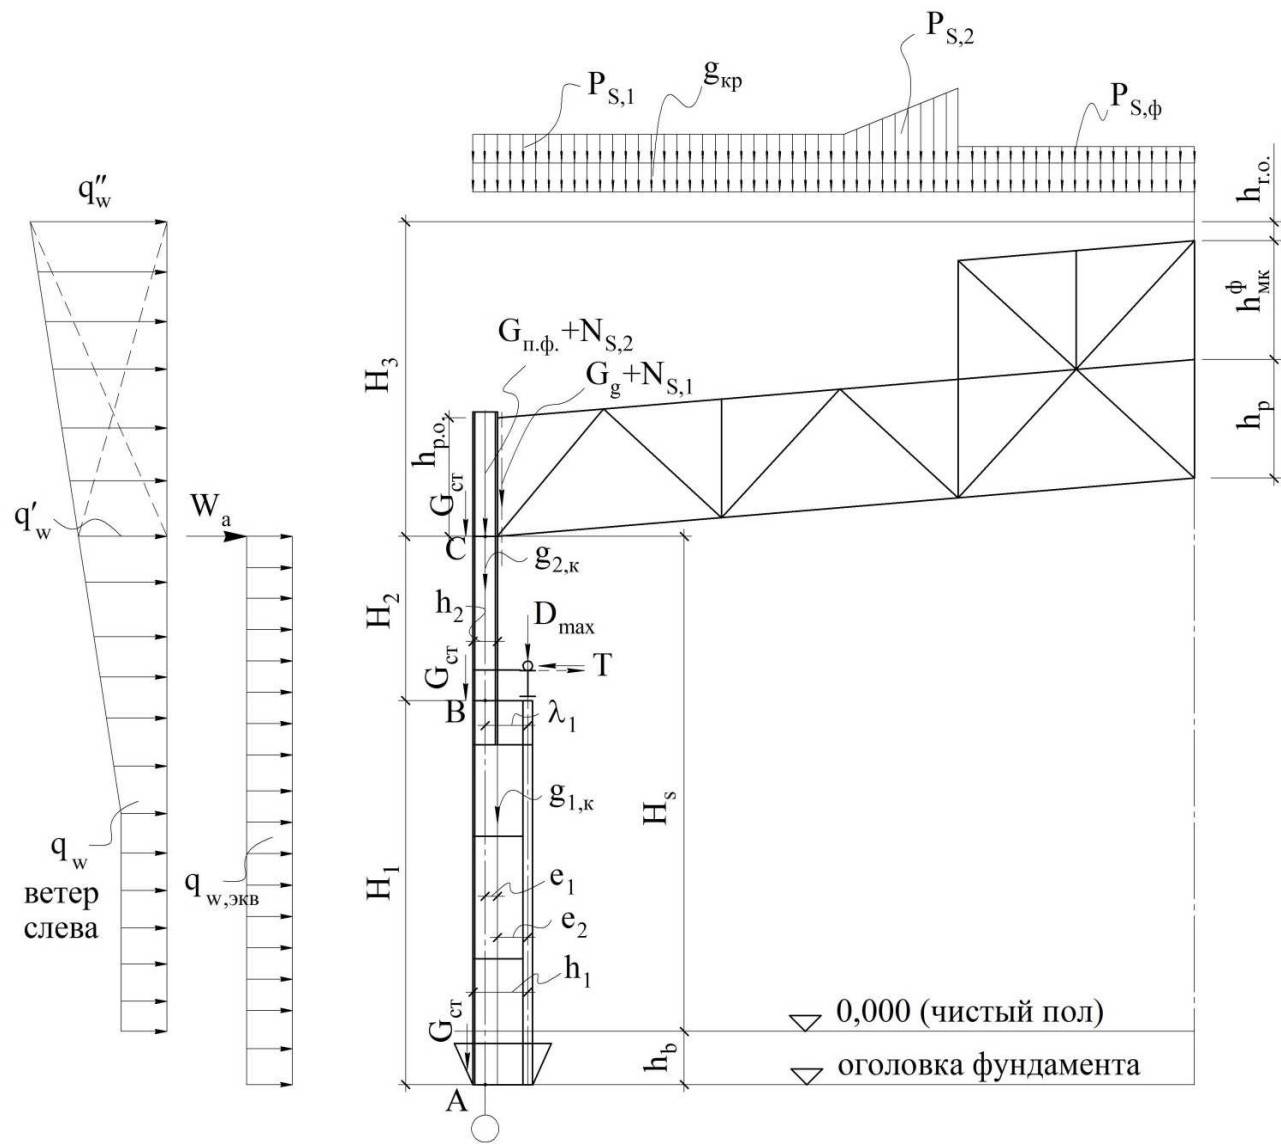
Конструктивная схема поперечной рамы с нагрузками на крайний пролет
